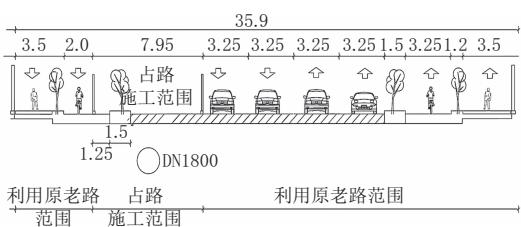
国庆路(乌镇路—晋元路)道路新建工程恒通路施工翻交断面图(单位:m)
